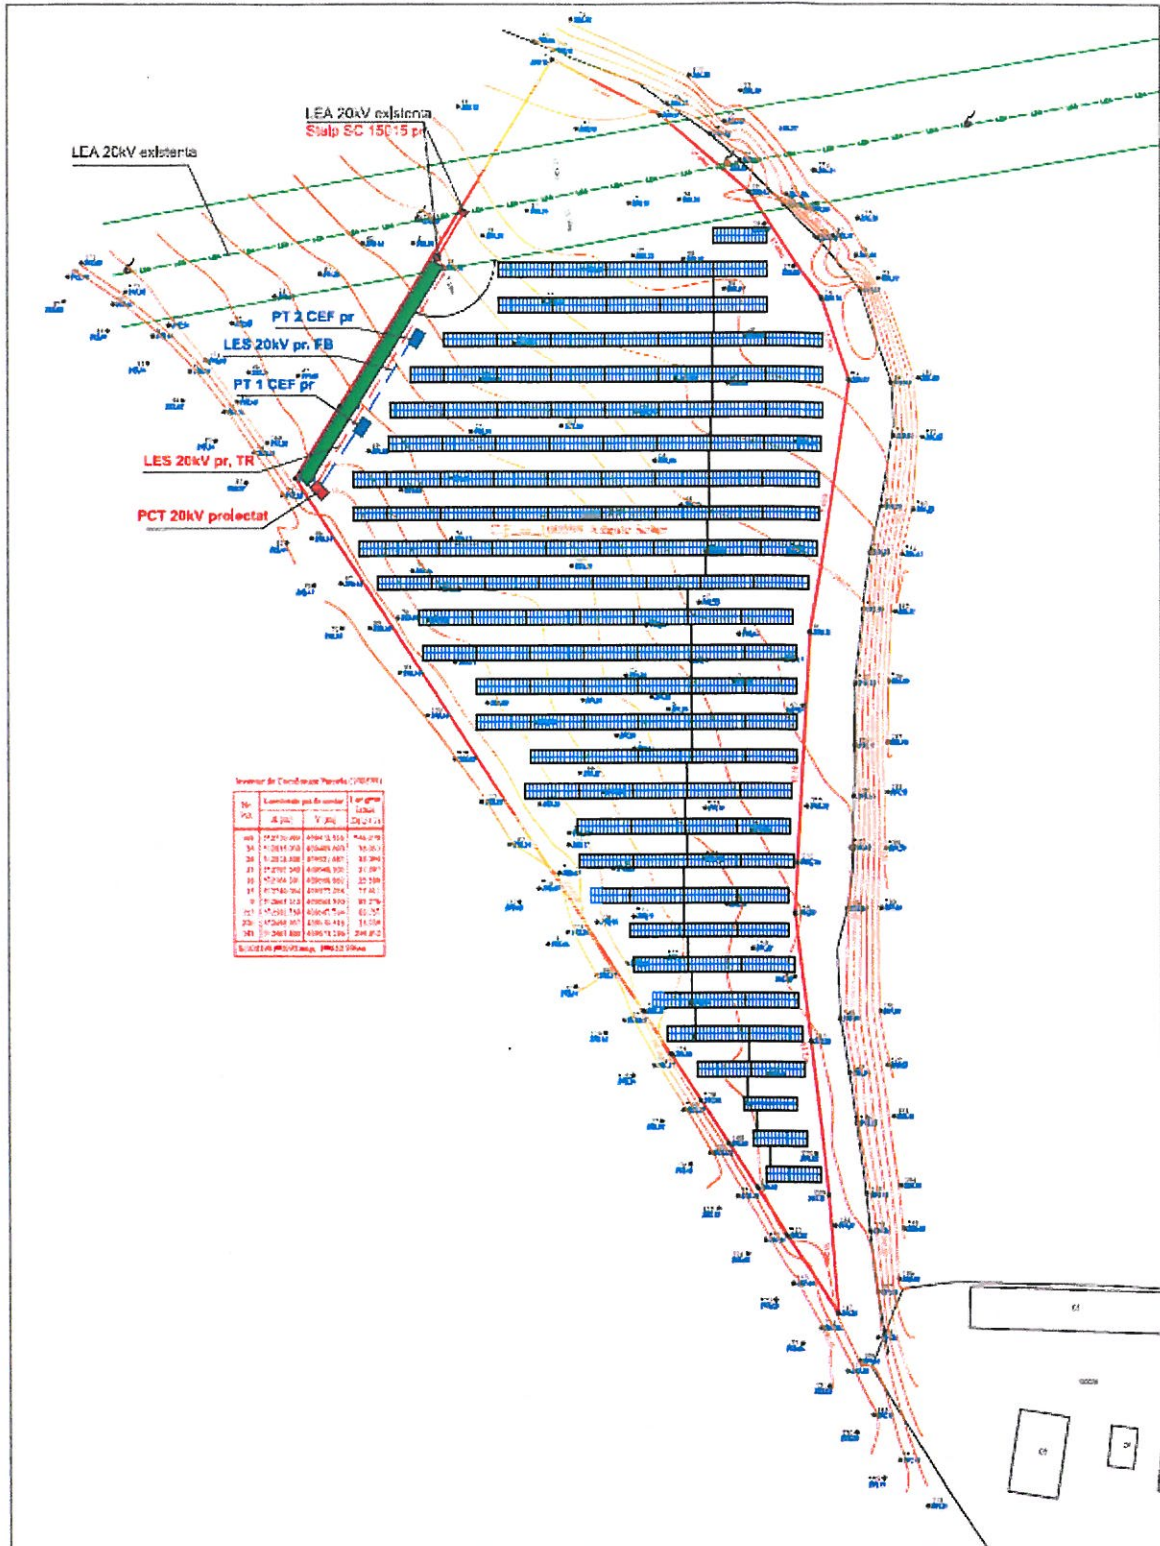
Detalii privind situația propusă (sursa: Plan de situație, planșa 2, S.C. ELECTROENERGETIC DESIGN S.R.L., 2023)
